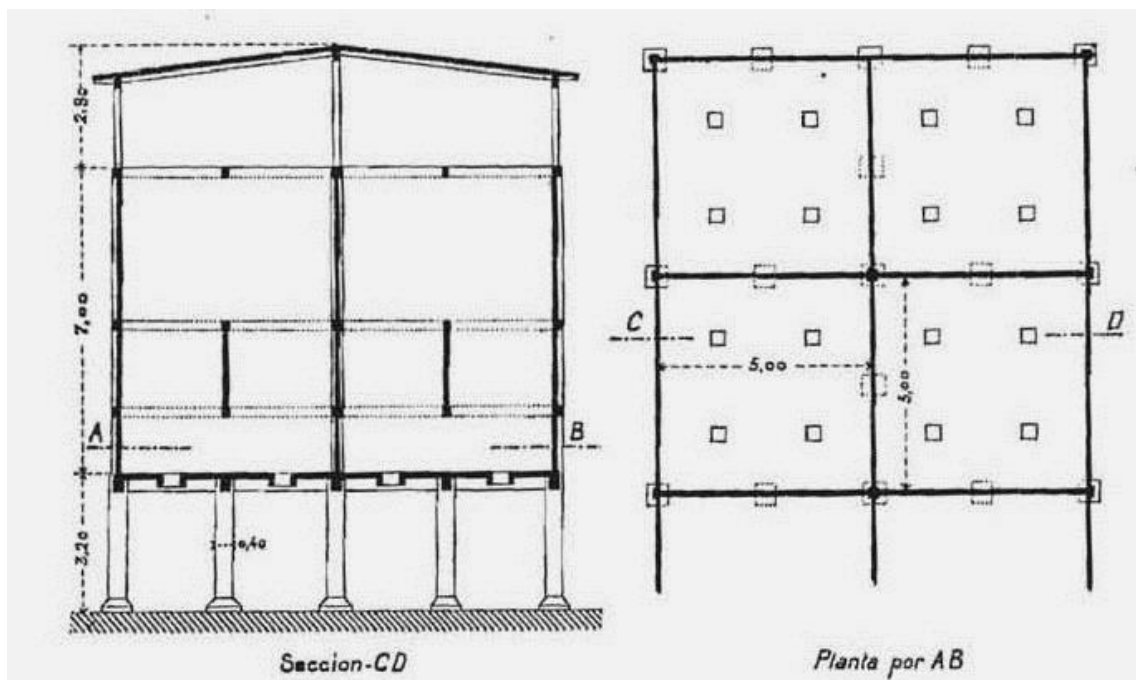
Planta y sección de la segunda batería de silos de Tudela Veguín. Revista El Cemento Armado No. 9 año 1901
